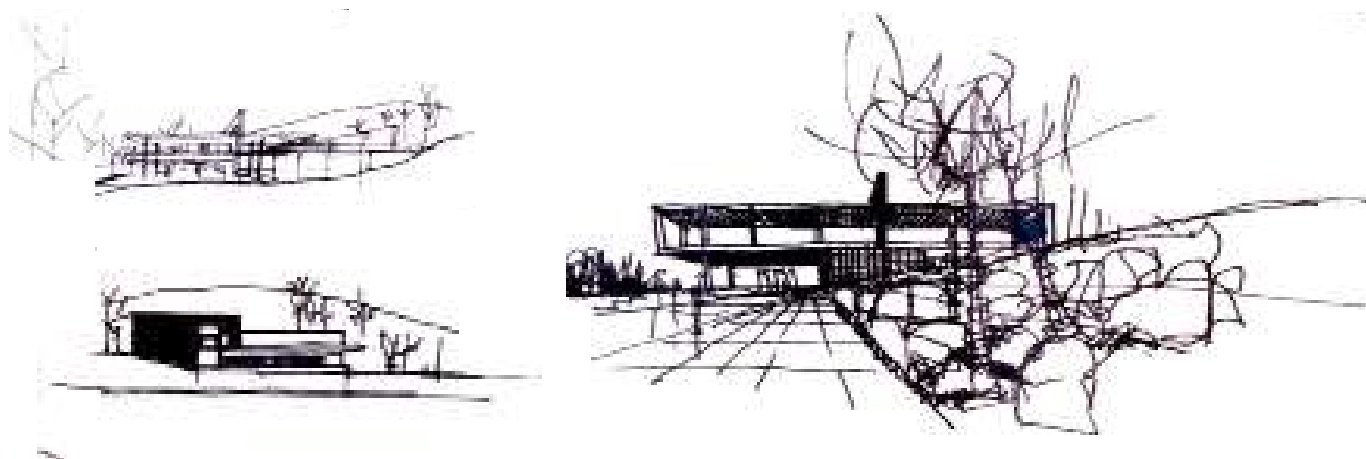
Proceso para construir un dibujo arquitectónico con un grado de acabado de croquis
